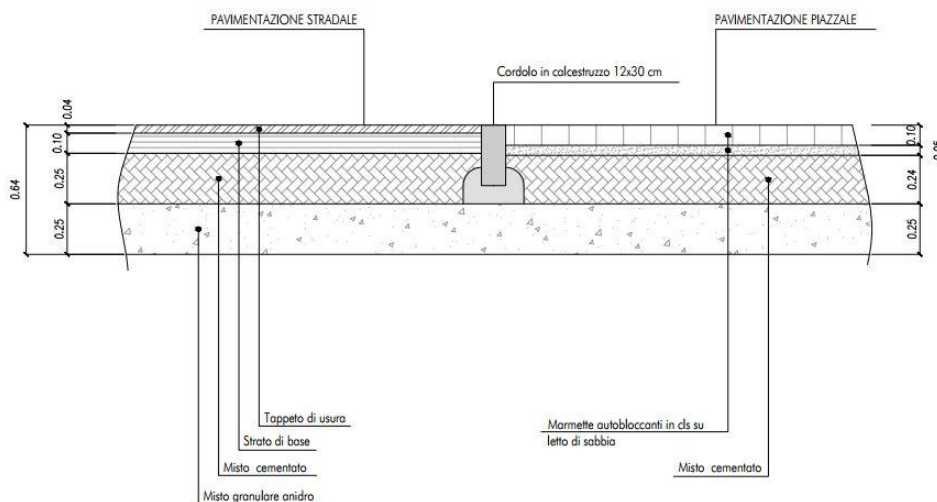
Pacchetti di pavimentazione piazzali e strade in progetto
